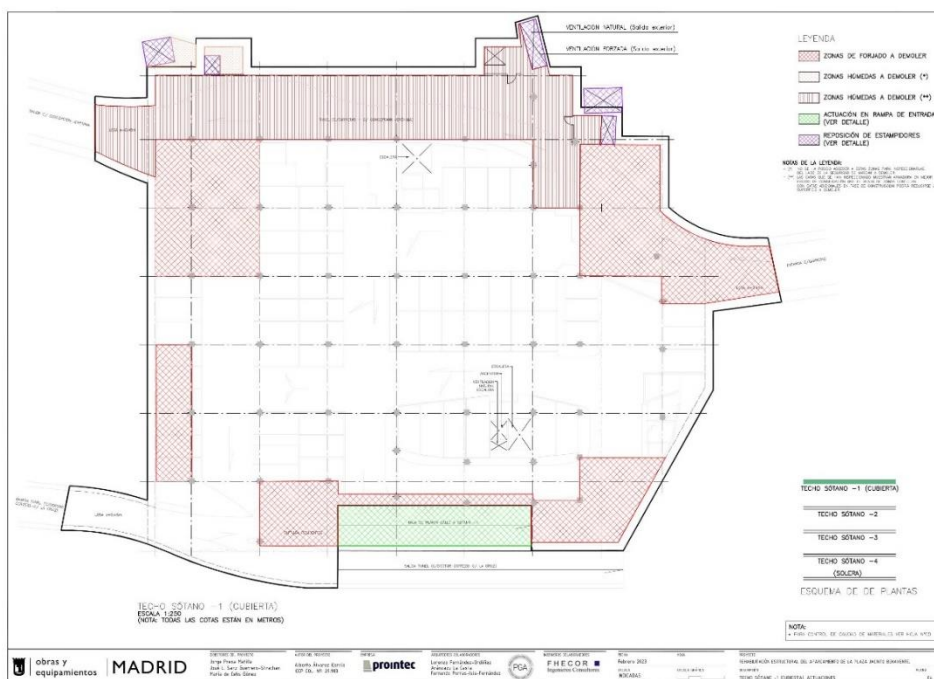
Plano Planta Cubierta que muestra las zonas confirmadas como húmedas, sombreadas en rojo
